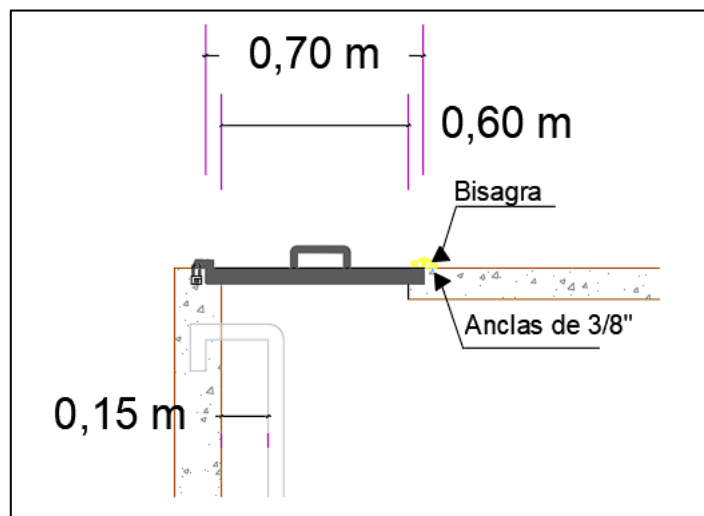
Armado del tanque de captación vista en planta [Barahona & Rivas, 2022]
